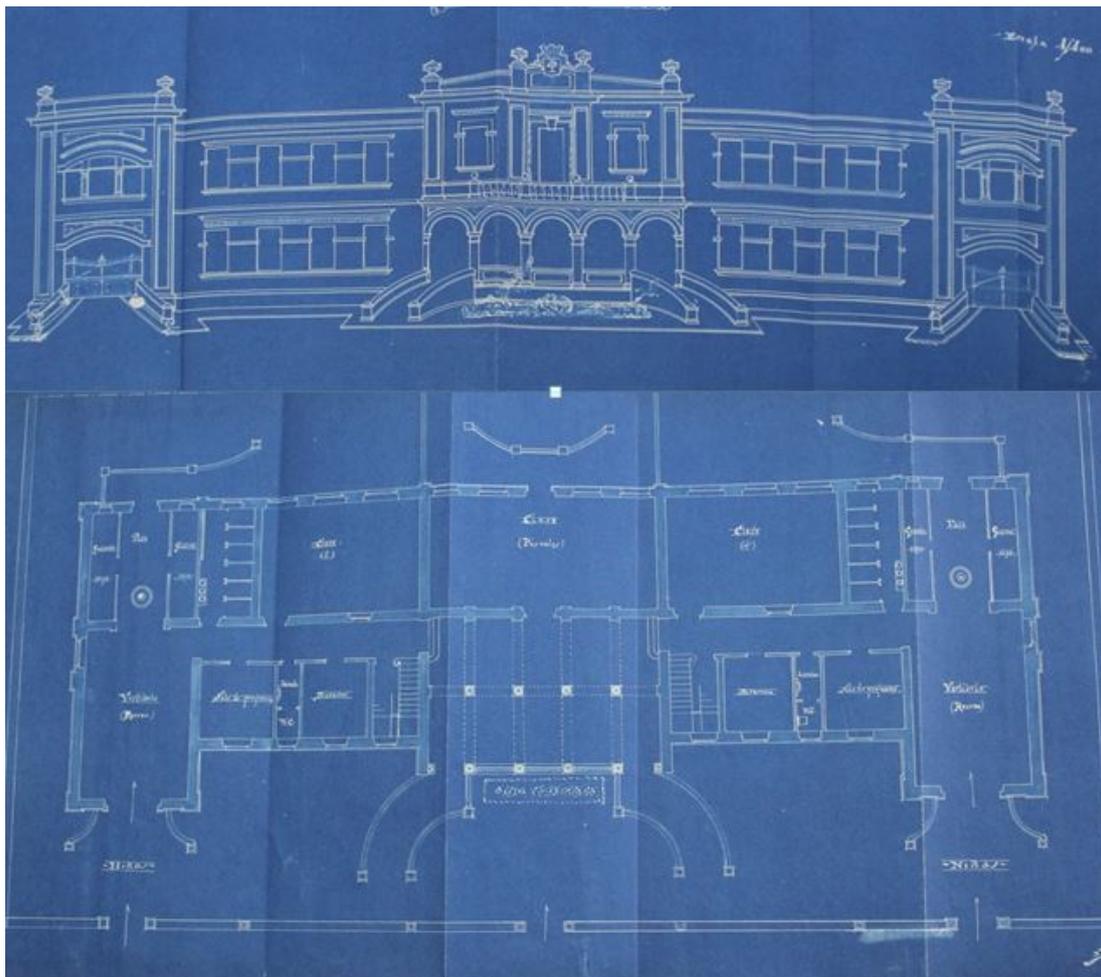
Planos de fachada y planta del grupo escolar San Antonio
